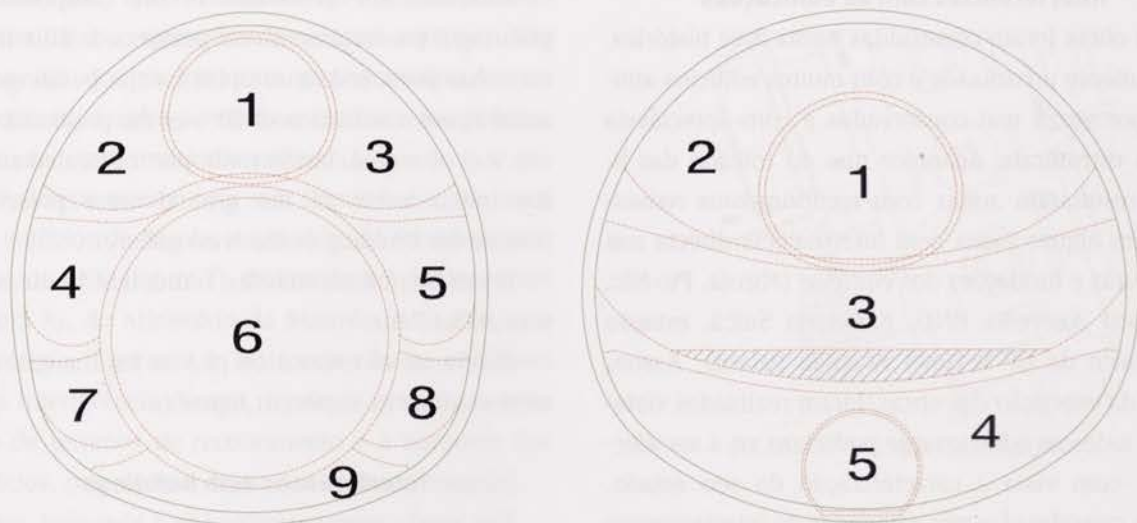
Fases de escavação para a construção da estação nascente e poente
